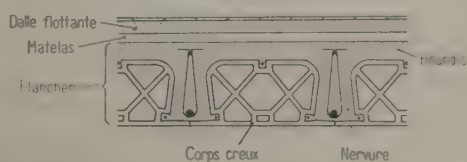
Vue en coupe d'un plancher avec dalle flottante.
